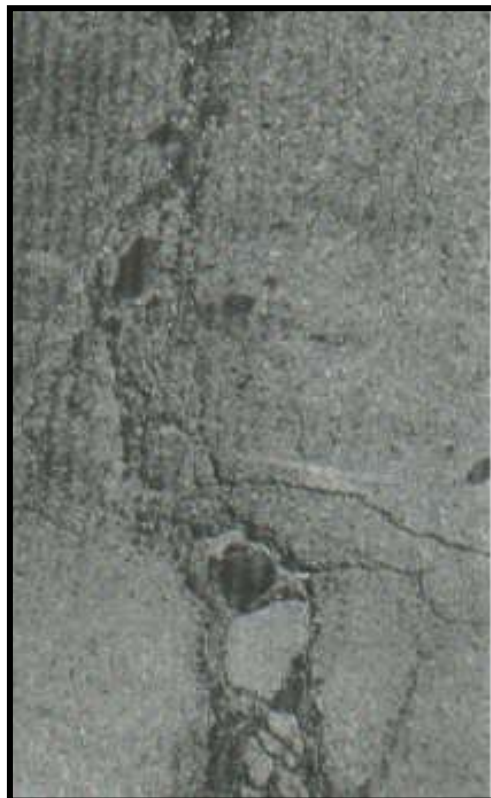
Nivel de Severidad Alto de Grietas Longitudinales y Transversales en el Pavimento.
